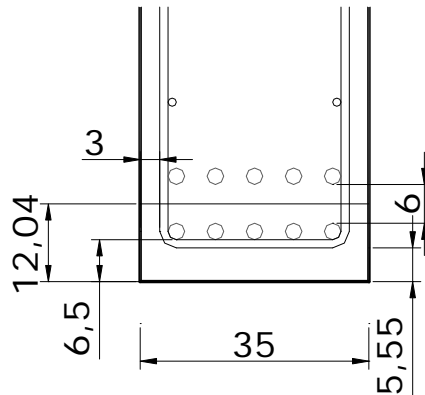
Detalle de la ubicación del refuerzo longitudinal por flexión
